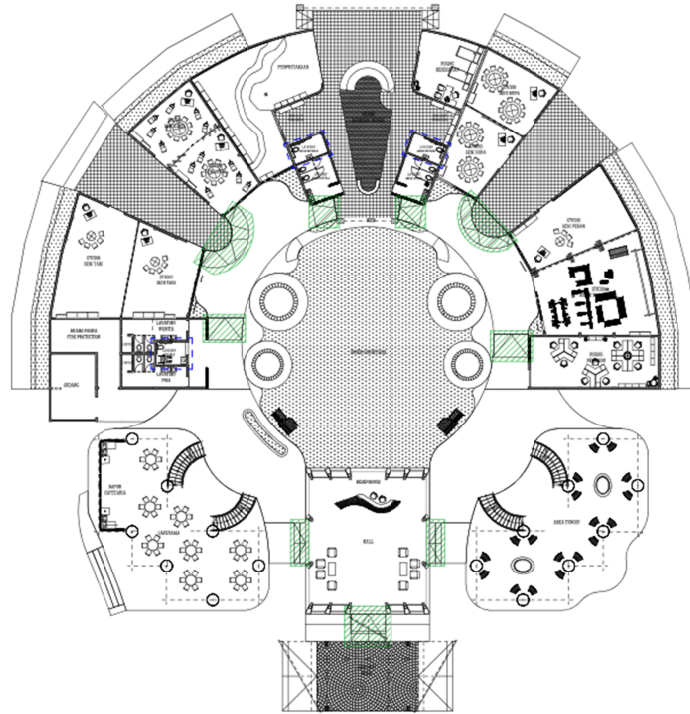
Skema Penghawaan Alami pada Ruang Kelas
